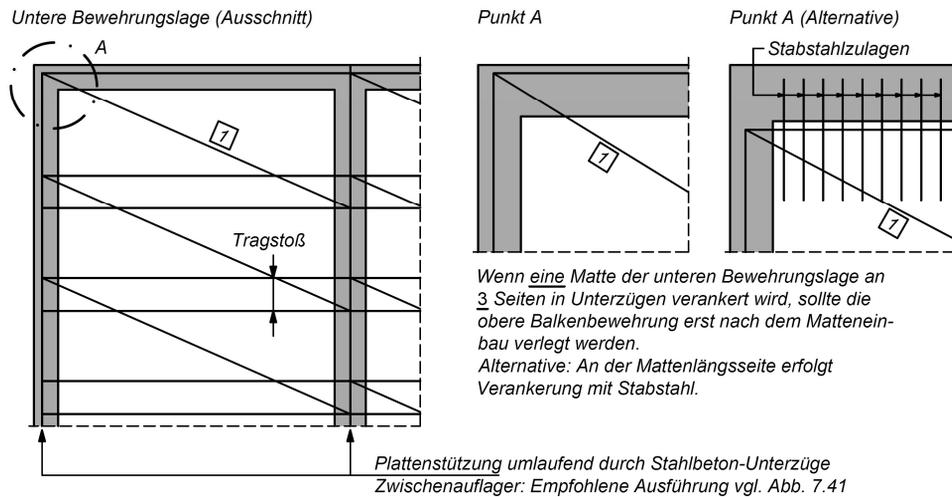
Zur Ausführung der unteren Bewehrungslage bei zweiachsig gespannten Platten auf Unterzügen
